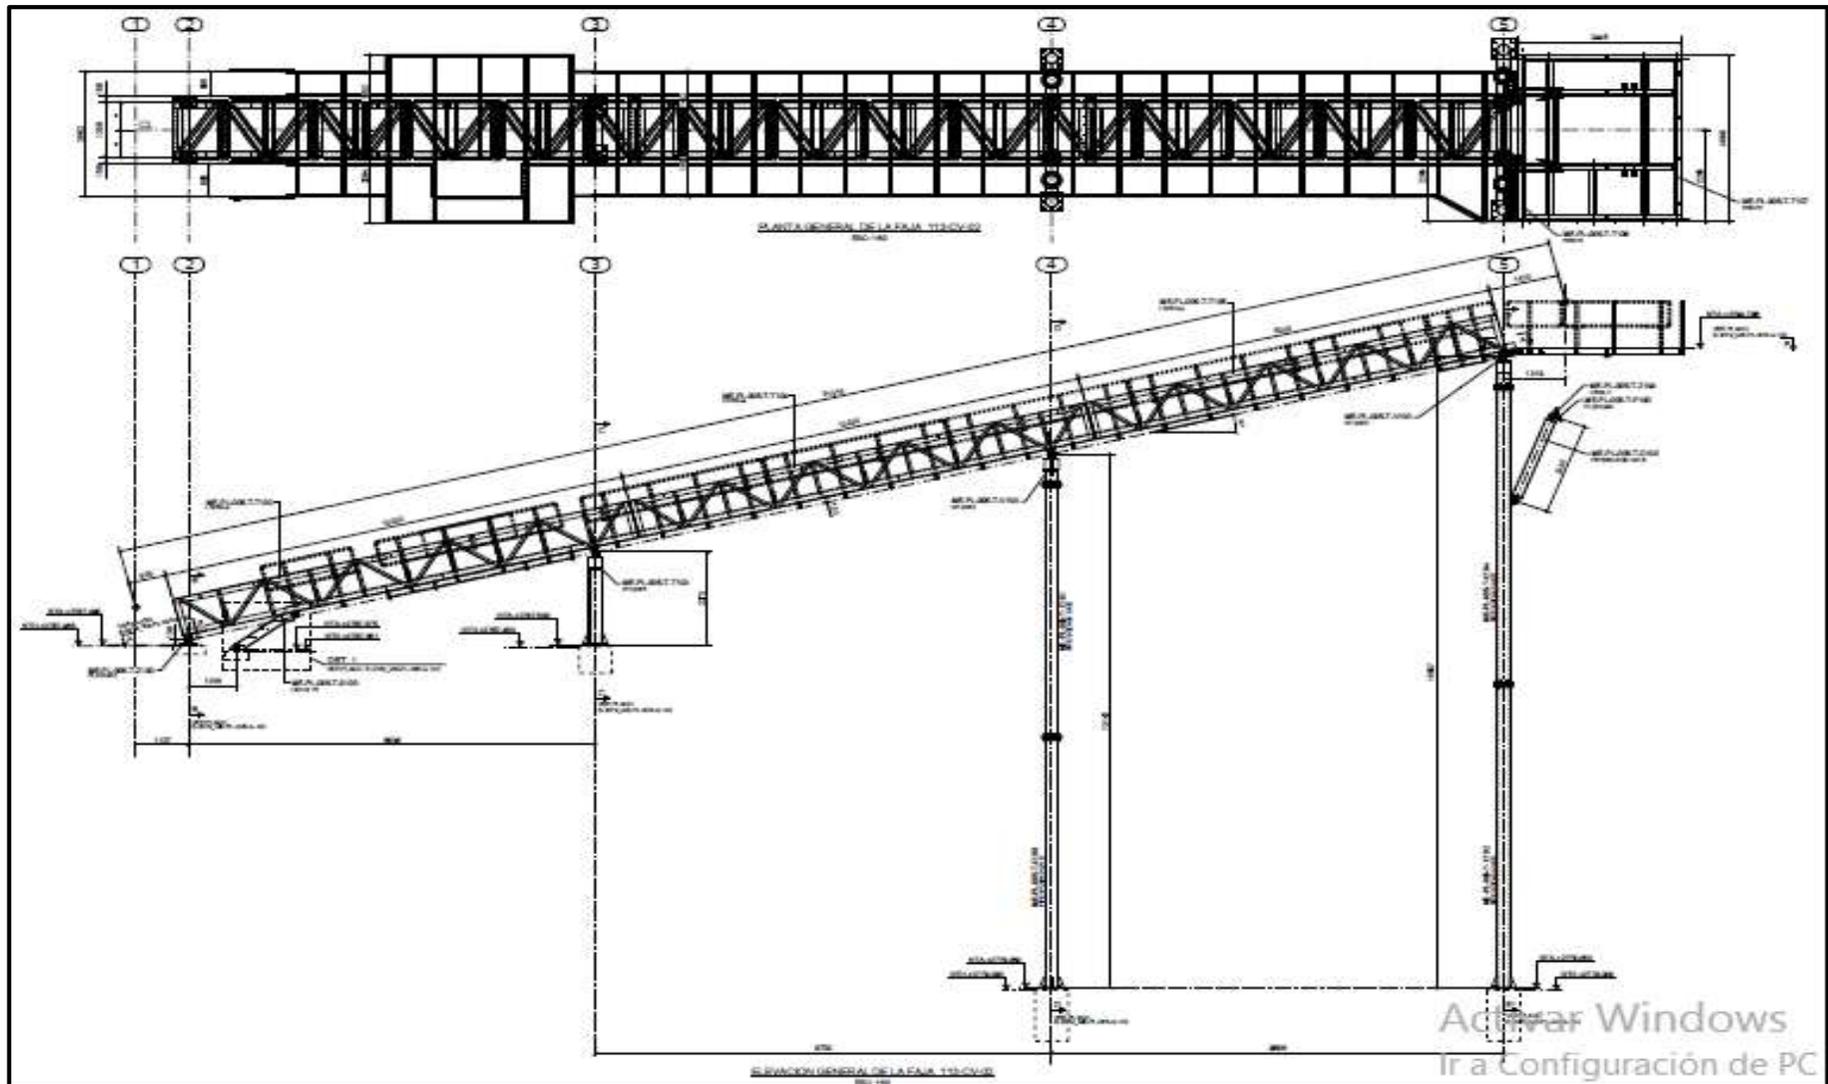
PLANO 1 - ESTRUCTURA METÁLICA DE LA FAJA TRANSPORTADORA
